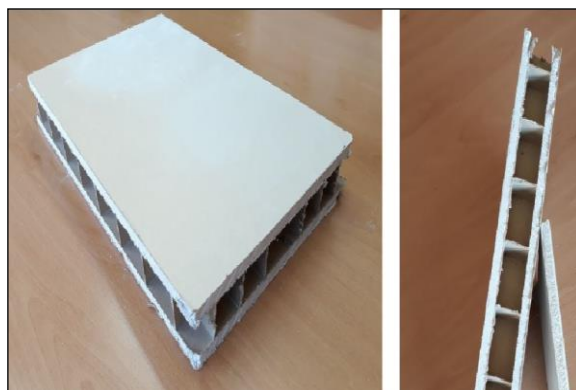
Panel de yeso-trillaje (vista general y vista en sección)
